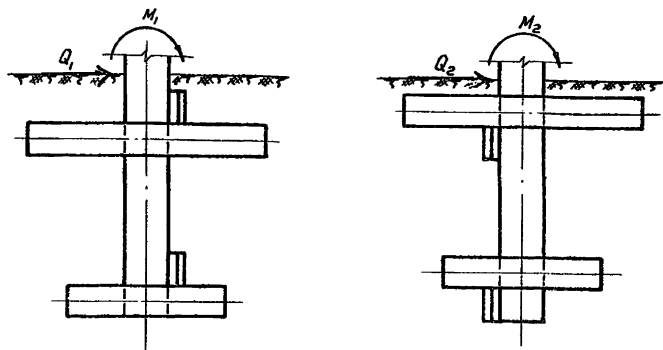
Двухригельное закрепление опрокидываемого узкого фундамента глубокого заложения
